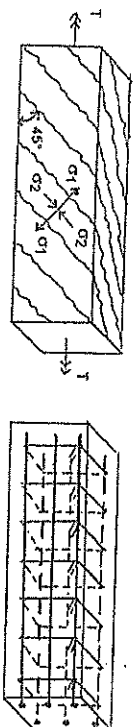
Armadura para torção constituída por barras longitudinais e estribos
